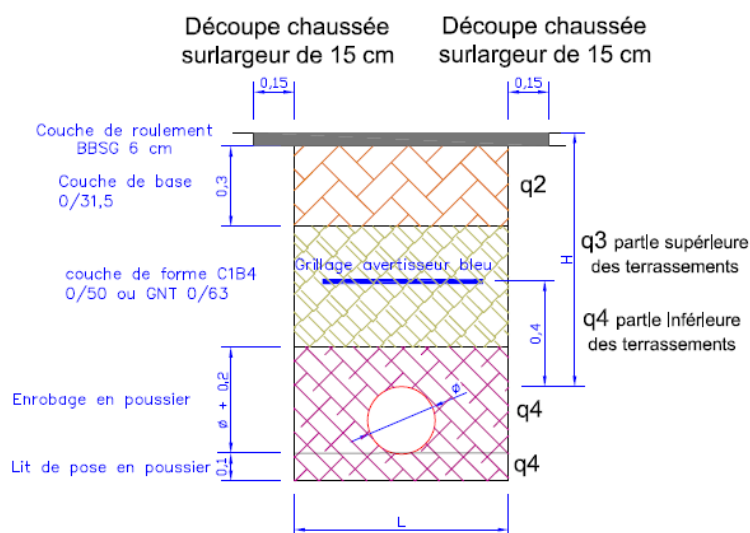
Coupe type tranchée sous accotement ou sous chaussée
